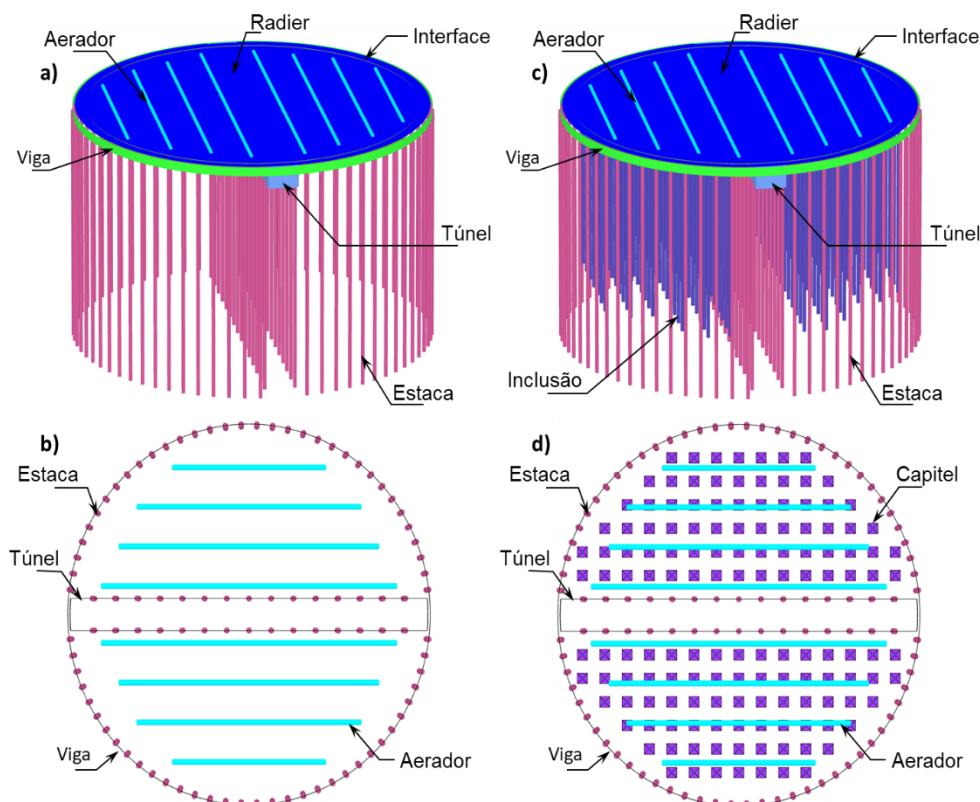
Silo a) vista 3D e b) planta do silo com estacas; e c) vista 3D e d) planta do silo com estacas e inclusões.
